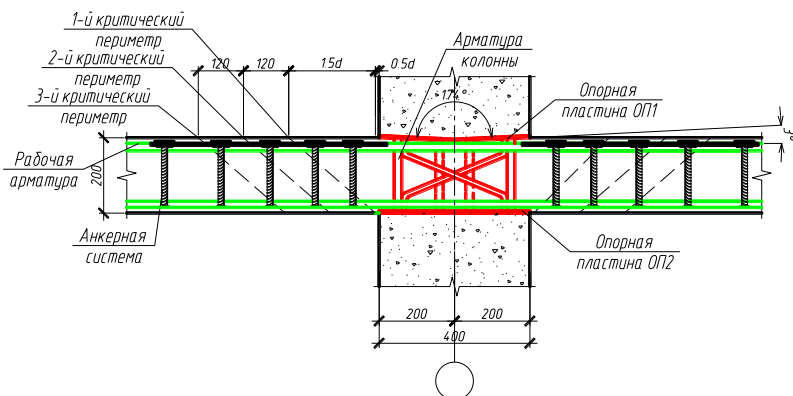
Вариант 1. Армирование плиты перекрытия в опорной зоне колонны с использованием анкерной системы в виде штырей арматуры периодического профиля класса S500
